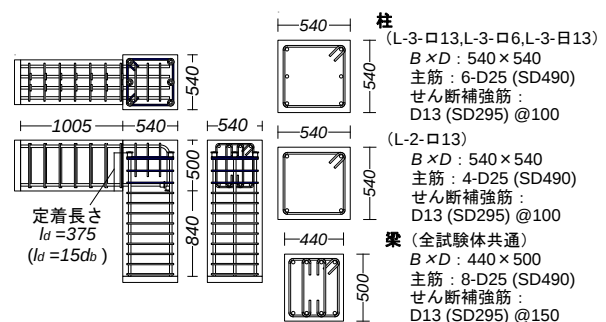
試験体形状および共通の配筋詳細図 (unit: mm)
